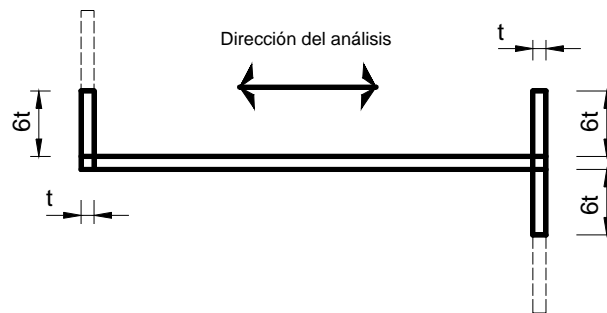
Ancho del patín a compresión en muros de mampostería que interviene en los EFP
